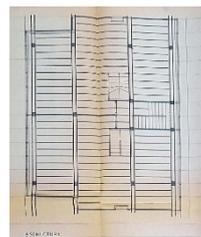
Planta primera dúplex Estructura B-3-5. 1964. Fuente: Archivo Municipal da Coruña
